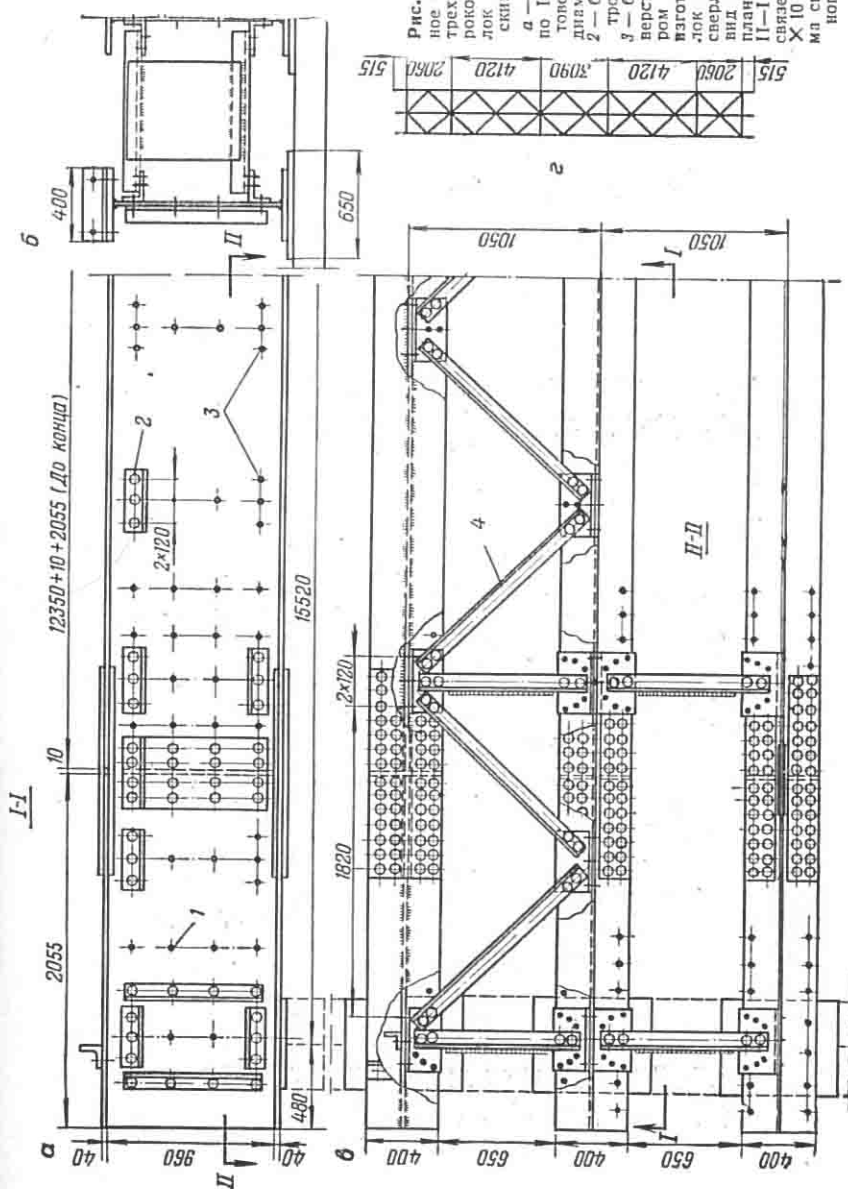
Пролетное строение из трех сварных шнорокопальных балок с металлческими связями:
